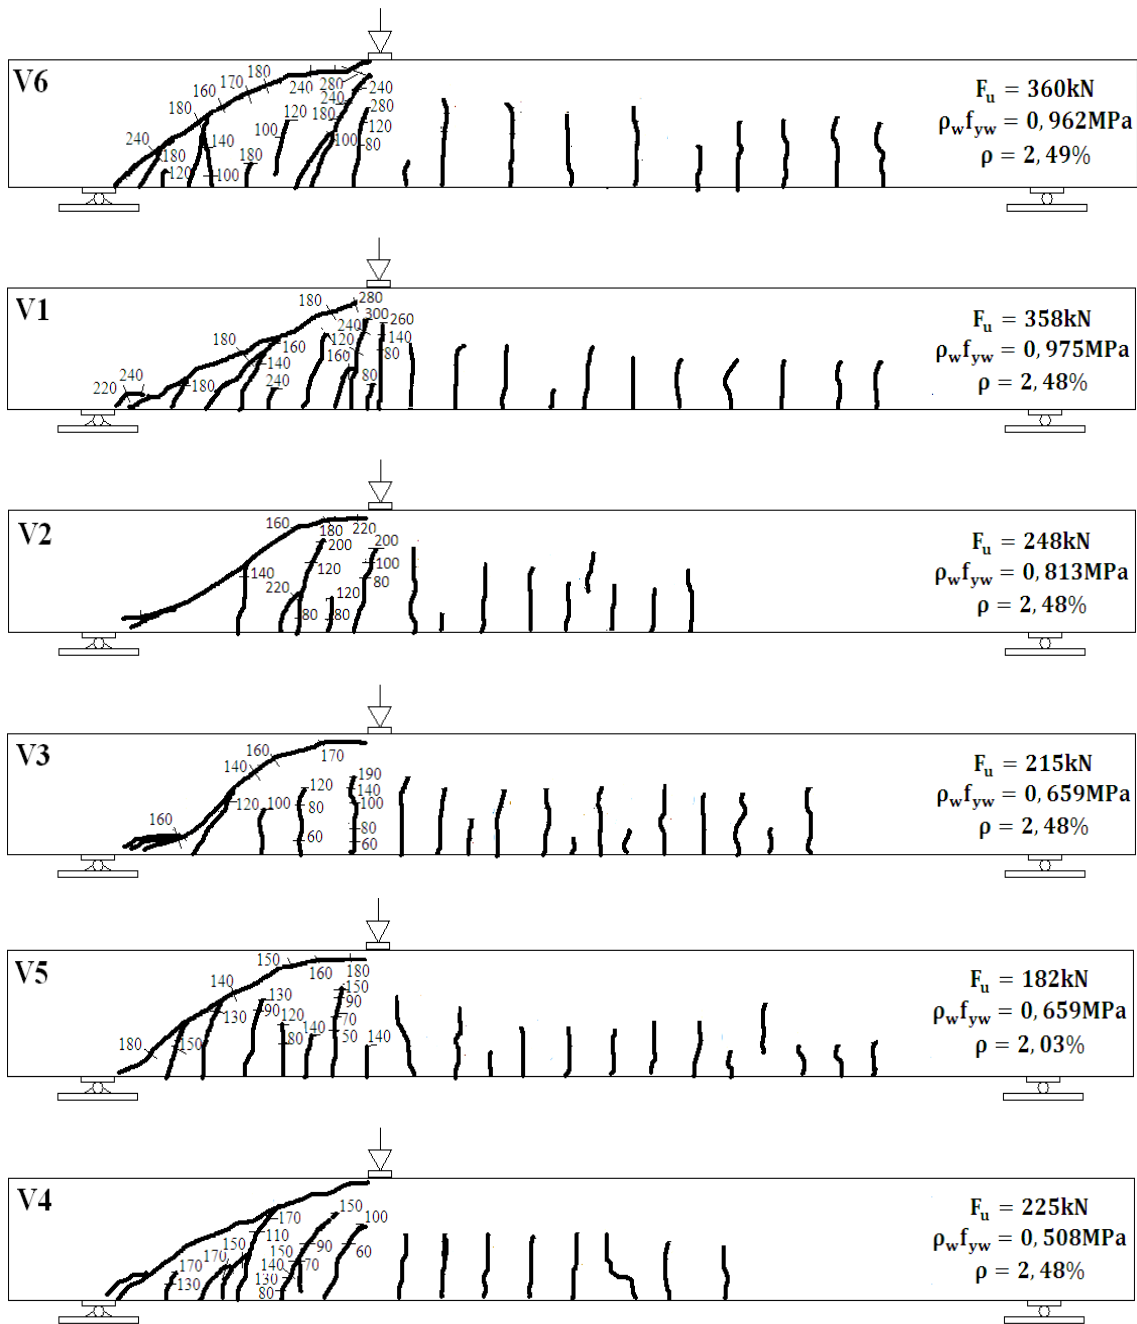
Esquema de fissuração das vigas ensaiadas.
